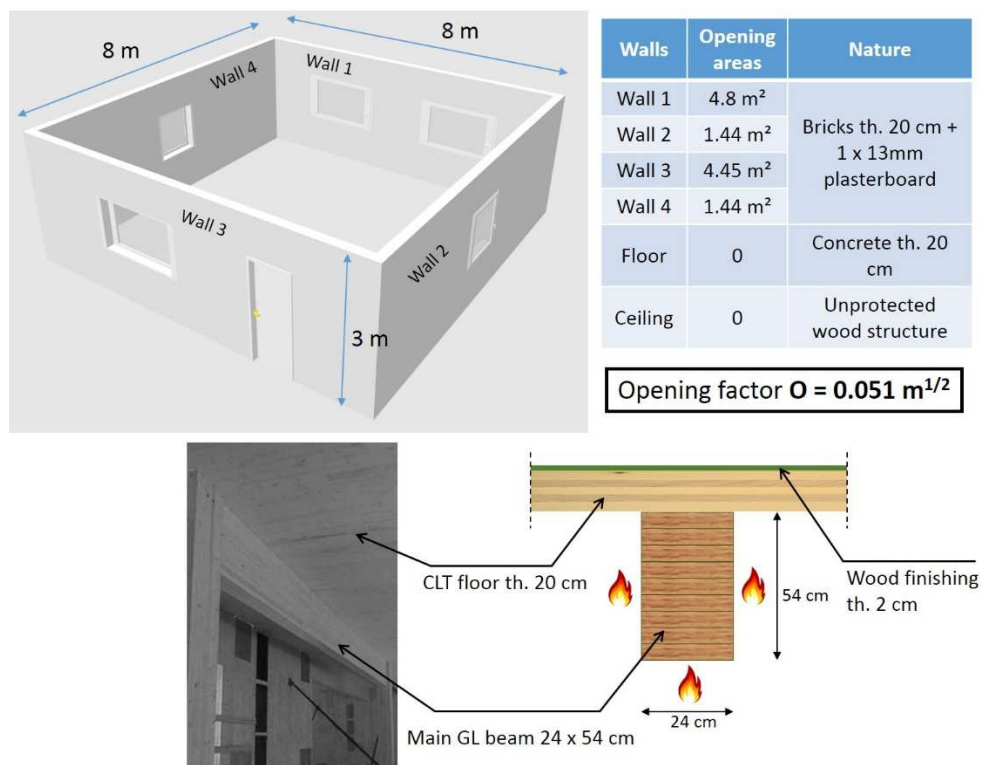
En haut à gauche : vue schématique en 3D de la pièce étudiée. En haut à droite : caractéristiques des murs et surfaces d'ouvertures. En bas à gauche : photo d'une poutre principale. En bas à droite : section transversale d'une poutre principale.
